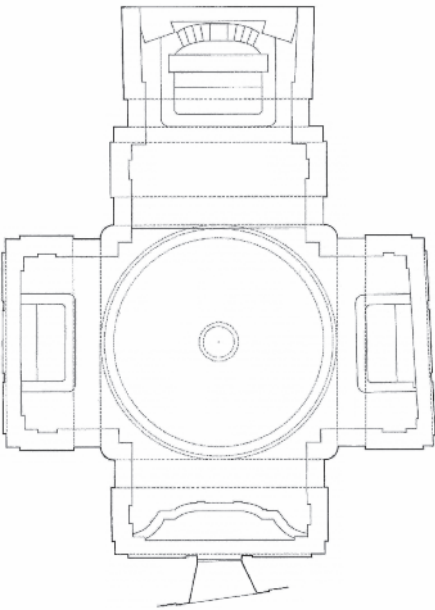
Pianta della chiesa a quota + 9.80 m (rilievo dell'autore).
